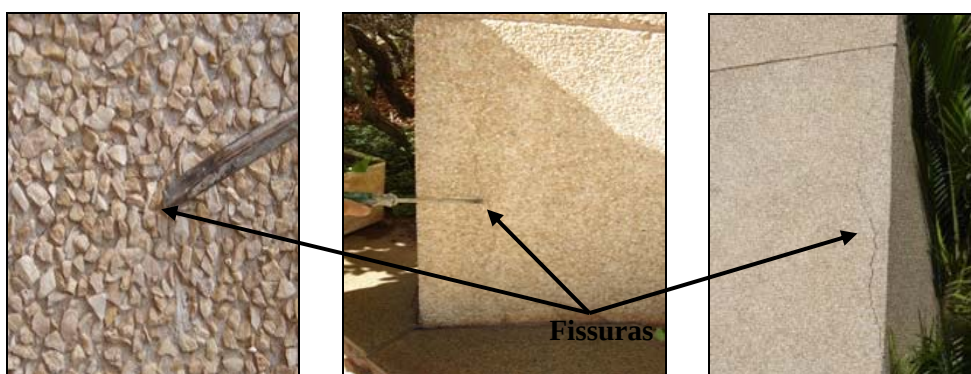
Fissuras no revestimento dos pilares do edifício 1
